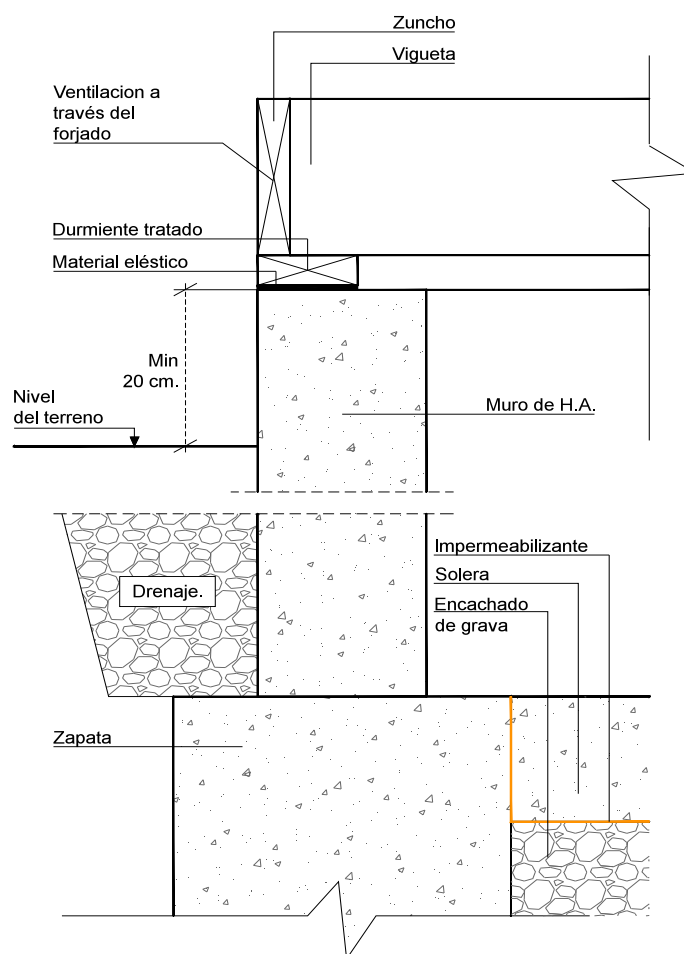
Encuentro entre el primer forjado y la cimentación en caso de existir sótano.
